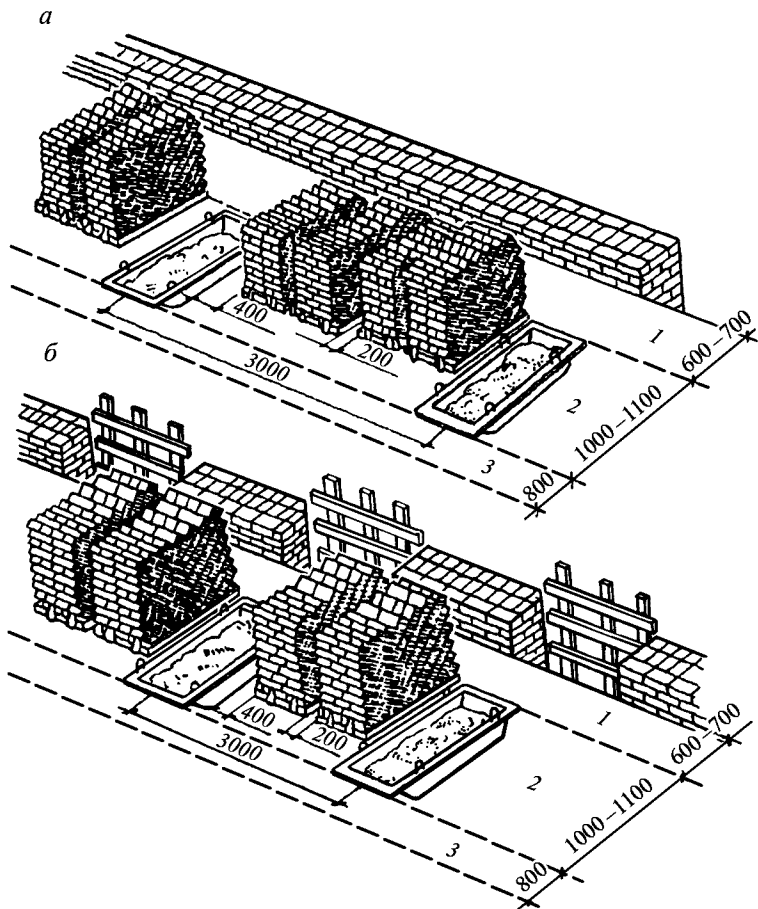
Рабочее место звена каменщиков при кладке глухой стены (а) и стены с проемами (б):
